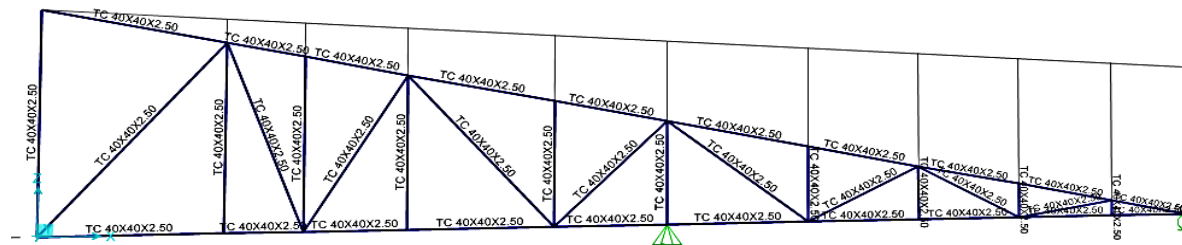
Modelo en SAP2000 de cercha tipo 2 para cubierta de la zona A. Fuente: Autor.
